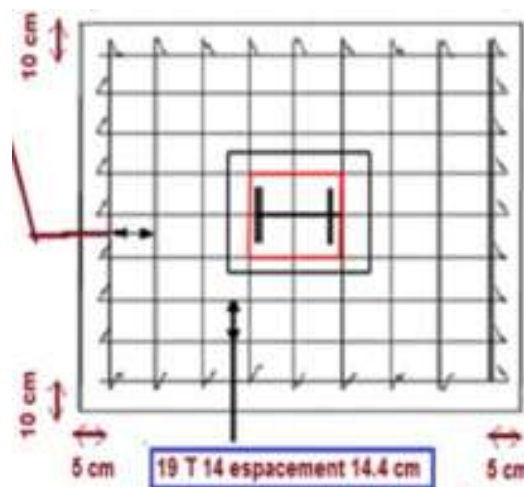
Le schéma de ferraillage de la semelle isolé.
